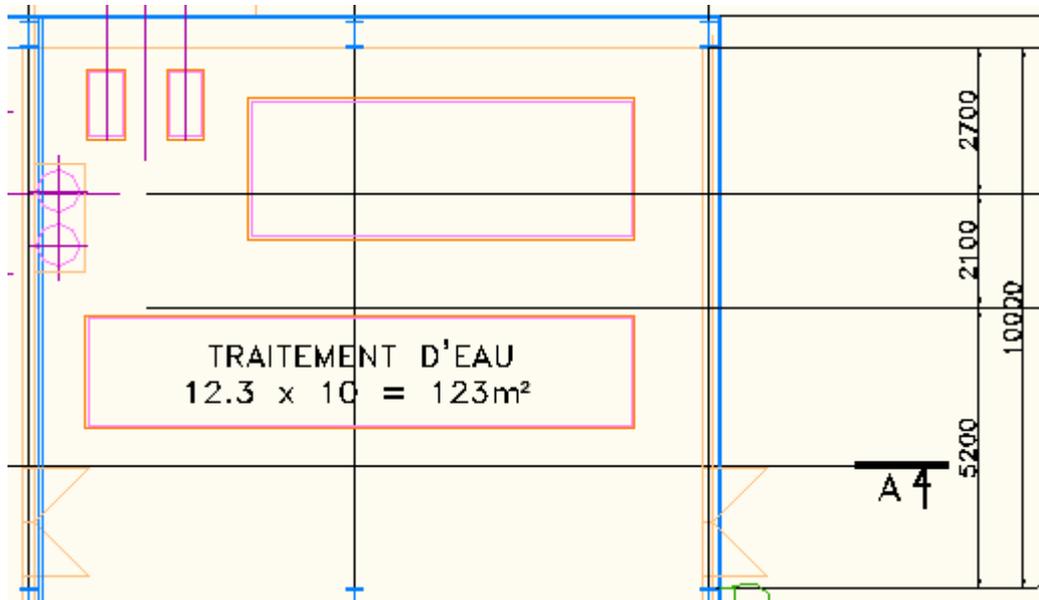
Plan du Local Traitement des eaux (vue du Sud-Ouest)
